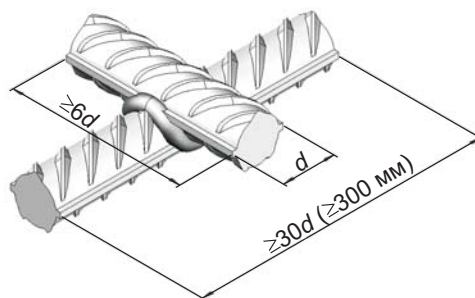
Контрольный образец крестообразного соединения для испытаний на растяжение
